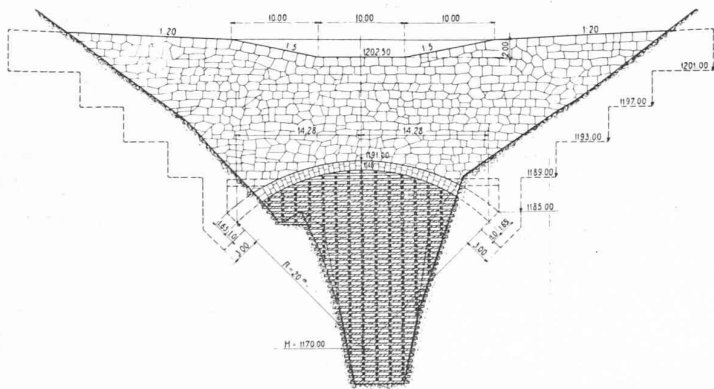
Barrage 6. — Elévation 1 : 800.
